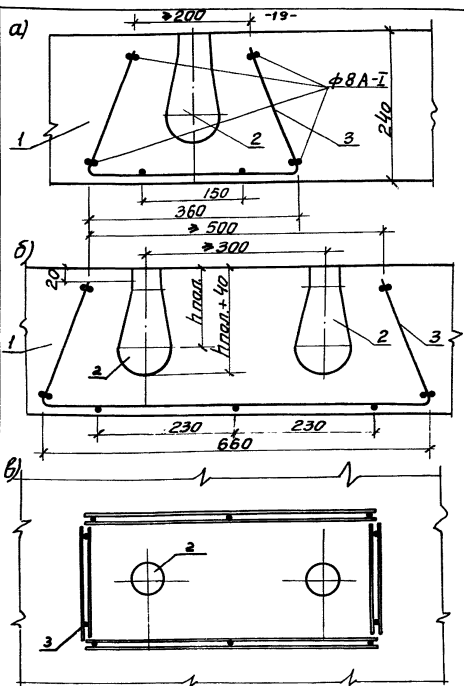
Рекомендуемый тип местного армирования при осевой нагрузке:
